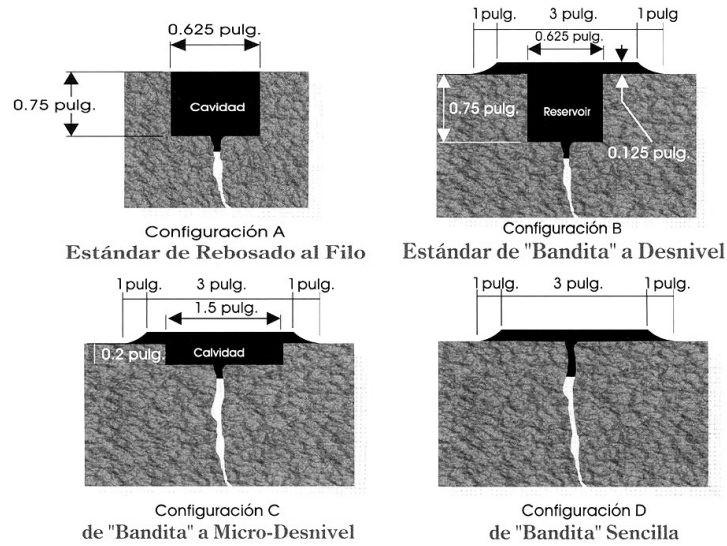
Ejemplo de cuadro de configuraciones para pavimento asfáltico
